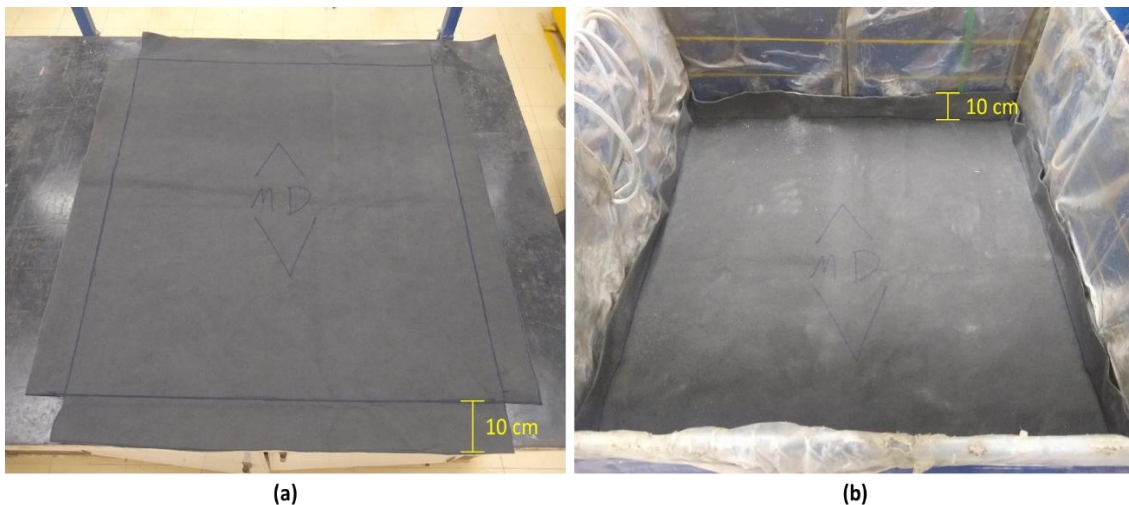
Segunda camada de reforço com comprimento de ancoragem: (a) cortada; (b) instalada.
